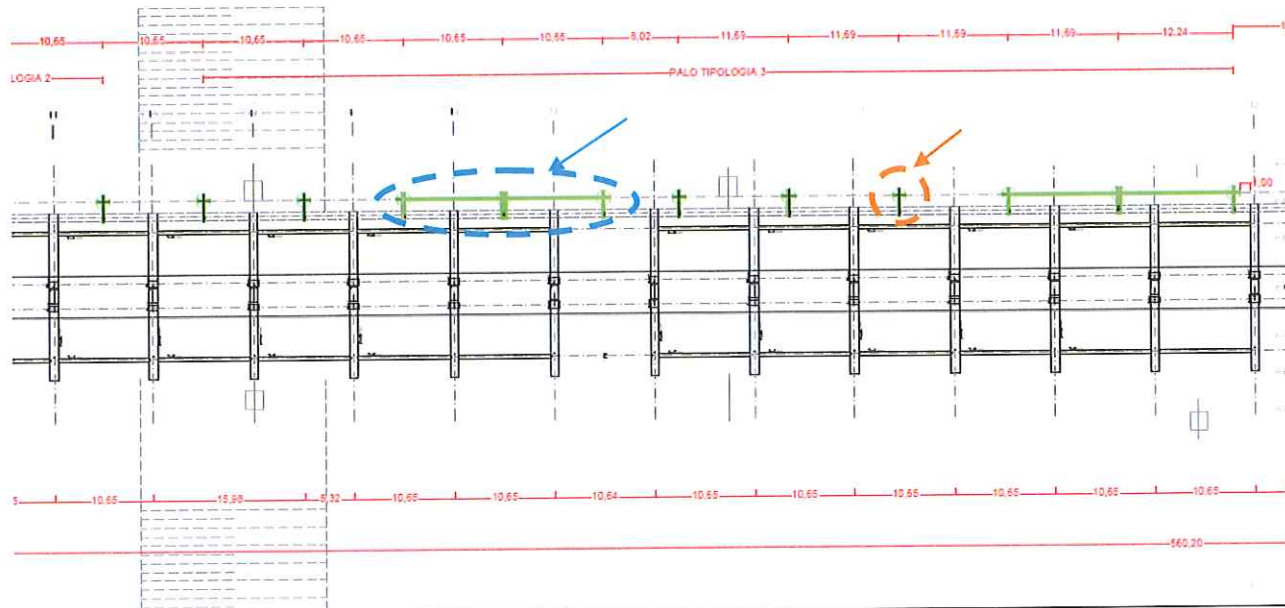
Stralcio planimetria intervento – Struttura porta tubazione
